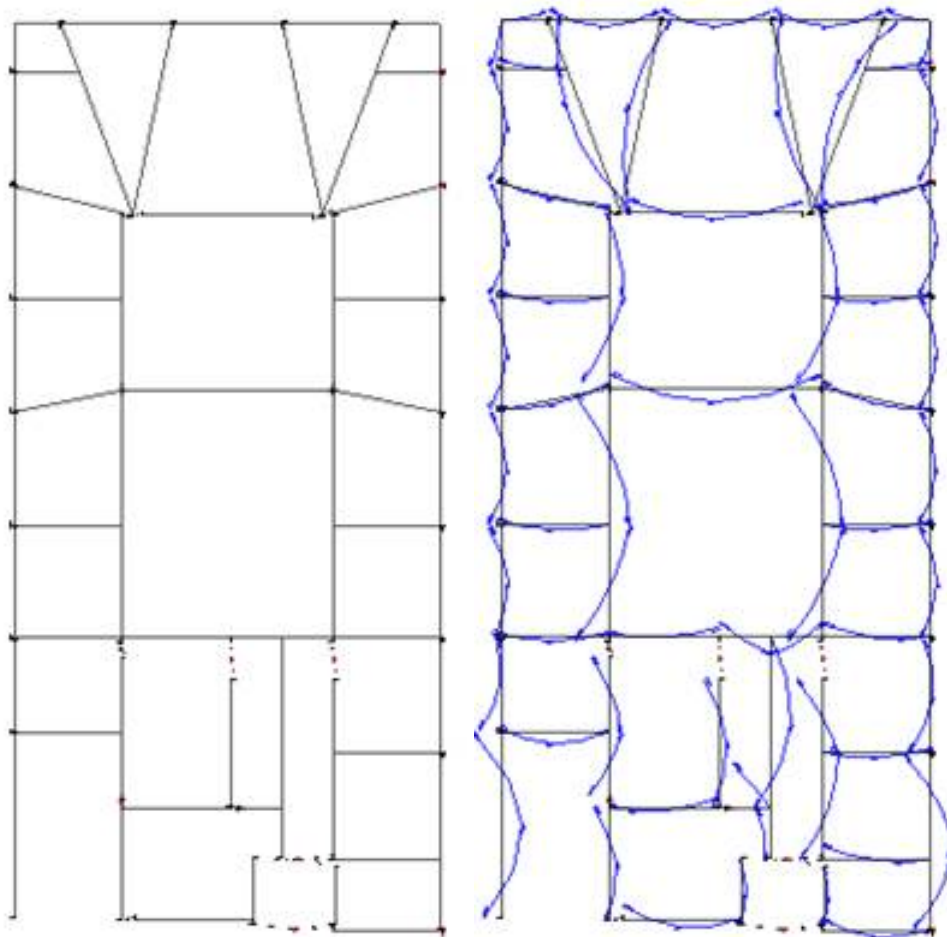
Pavimento em planta, e pavimento em planta com os diagramas rebatidos.
